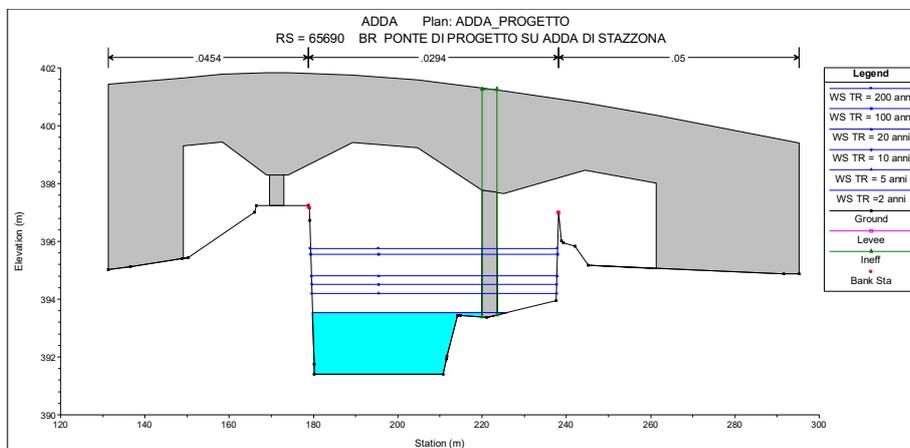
Sezione del fiume Adda presso il nuovo ponte di Stazzona (R.S. 65690), stato di progetto
